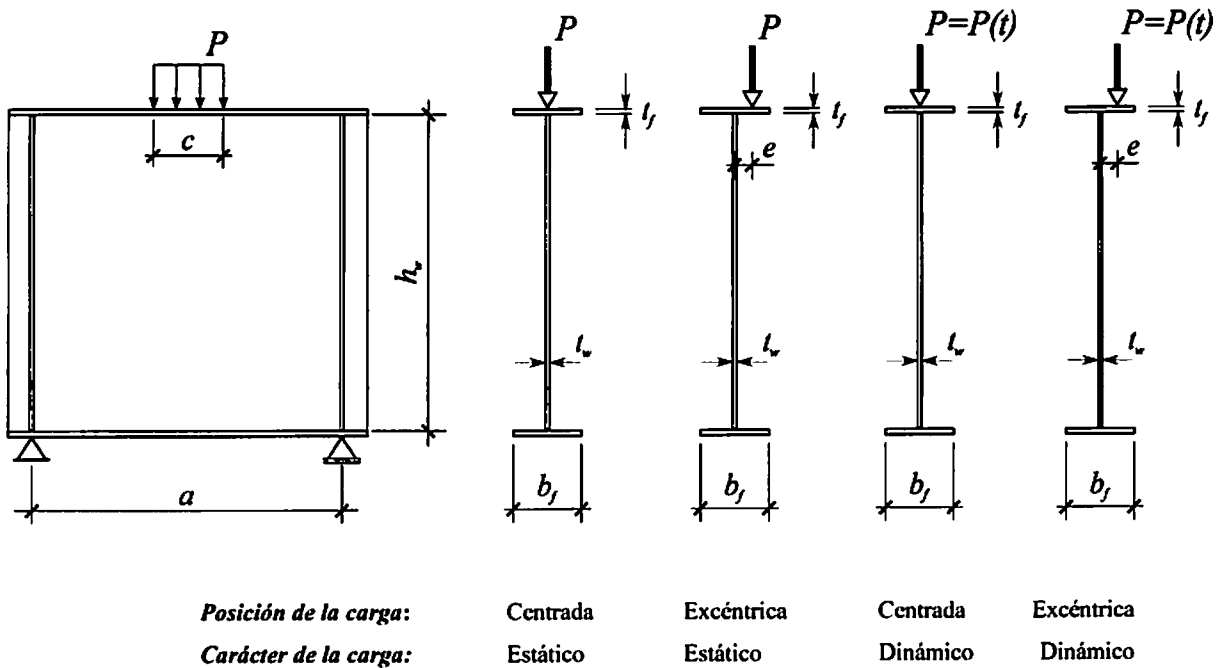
Casos característicos de cargas concentradas en vigas metálicas en I de débil espesor.
